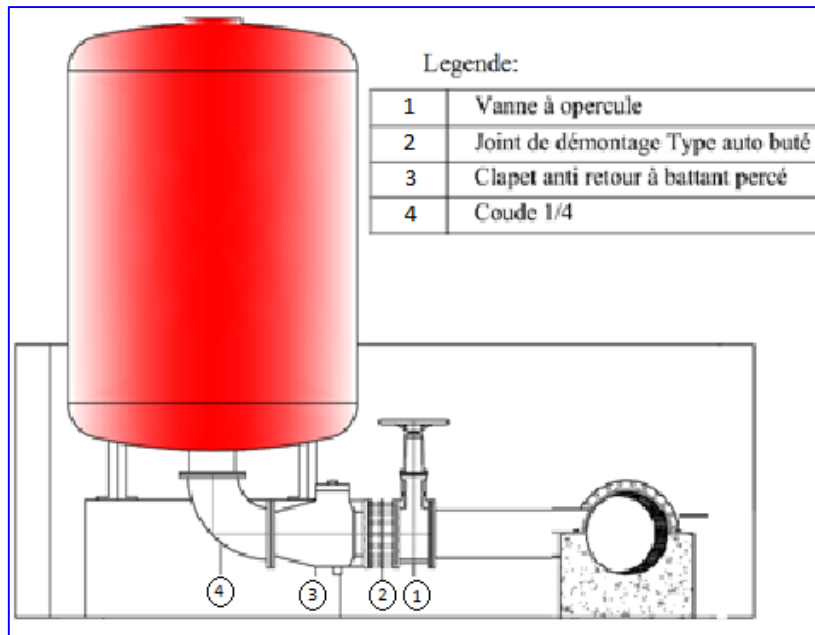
Schéma d'installation du réservoir d'air.
